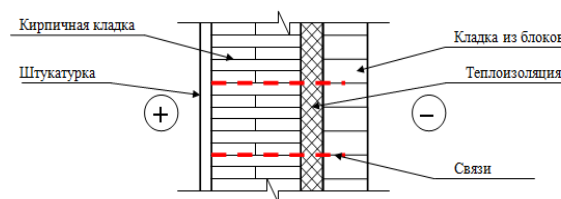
Конструкция несущей слоистой наружной стены с облицовкой кирпичом
